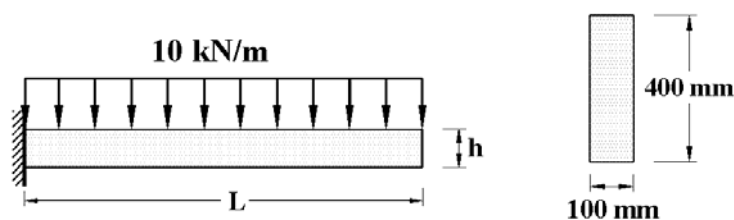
Viga em balanço com carregamento uniformemente distribuído
